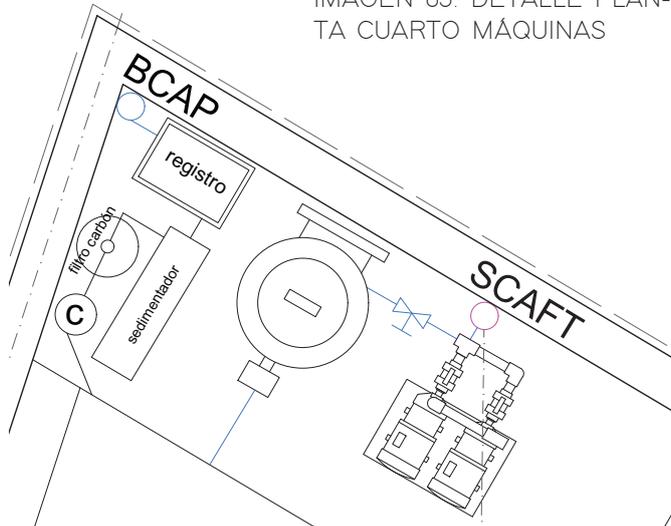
PLANTA CUARTO MÁQUINAS
